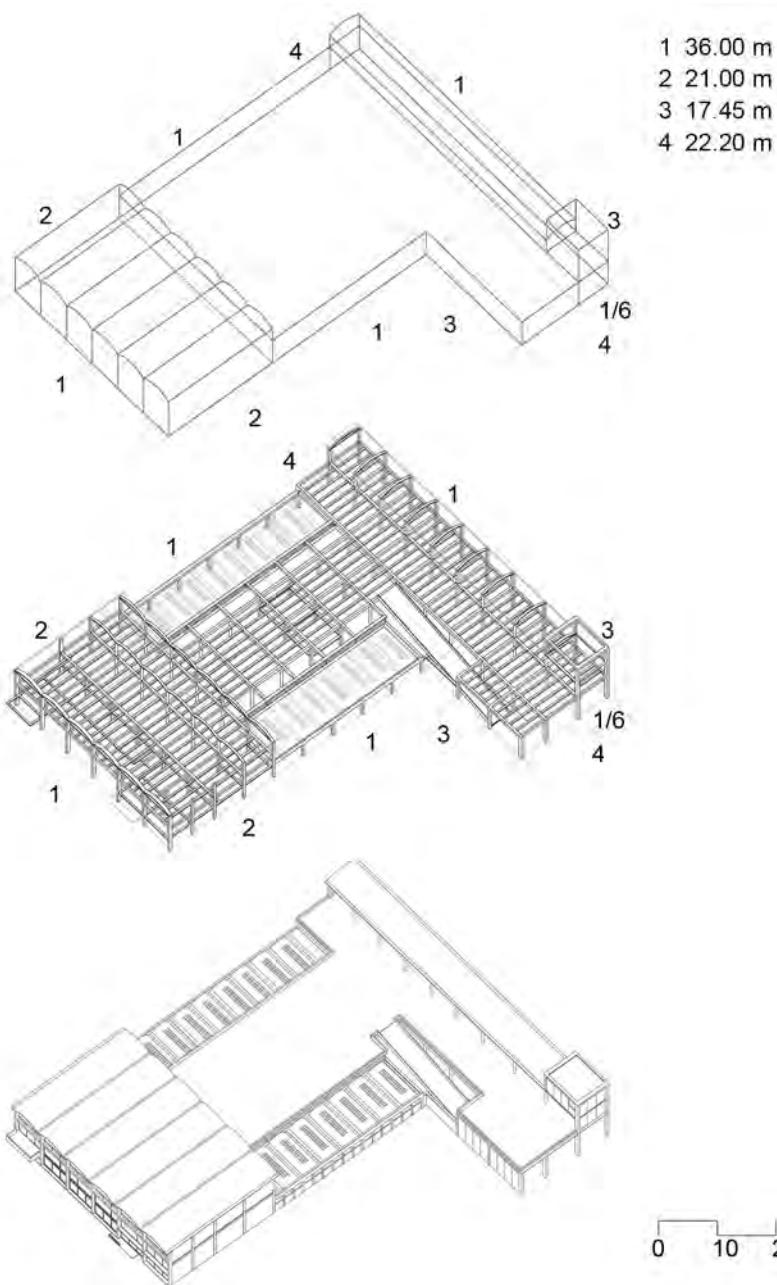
Volkswagen, dall'alto verso il basso: rapporti proporzionali, sistema strutturale, edificio completo dei settori di tamponamento. Fonte: elaborazione dell'autrice.
